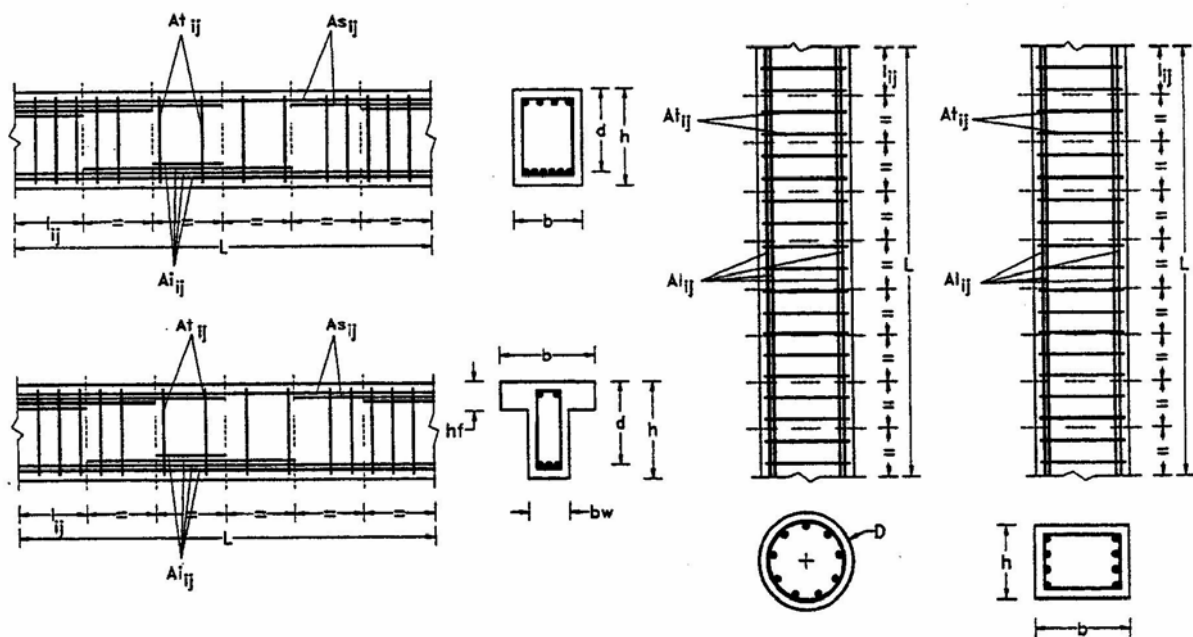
Variables de diseño de propiedades y de armado para los distintos elementos estructurales considerados
